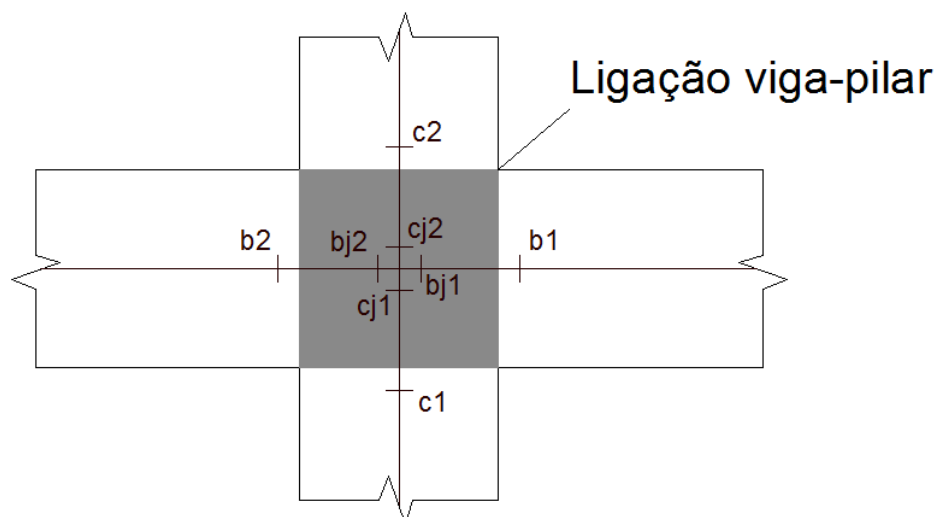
Geometria da ligação viga pilar e identificação de secções relevantes dos elementos lineares.
